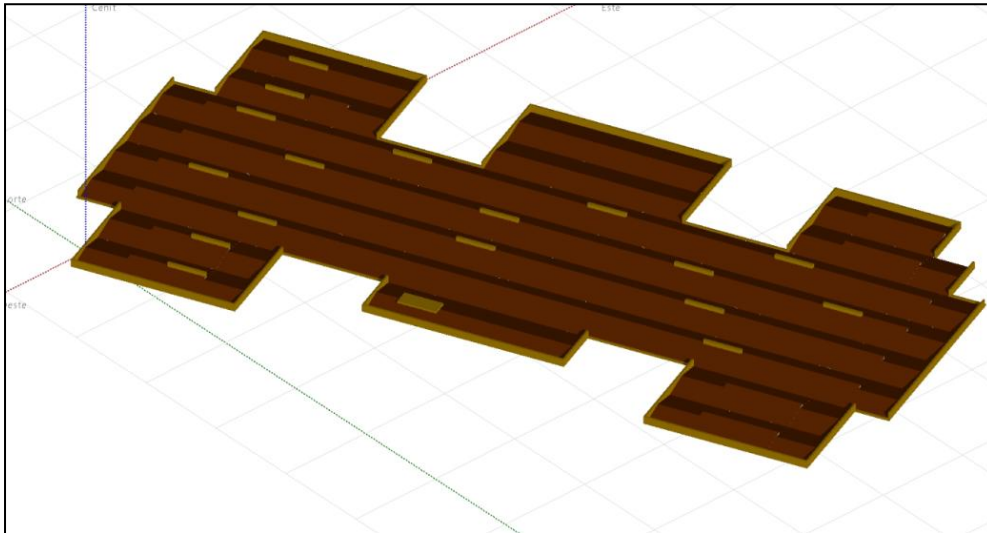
Modelado cubiertas edificio en detalle [Elaboración propia]
